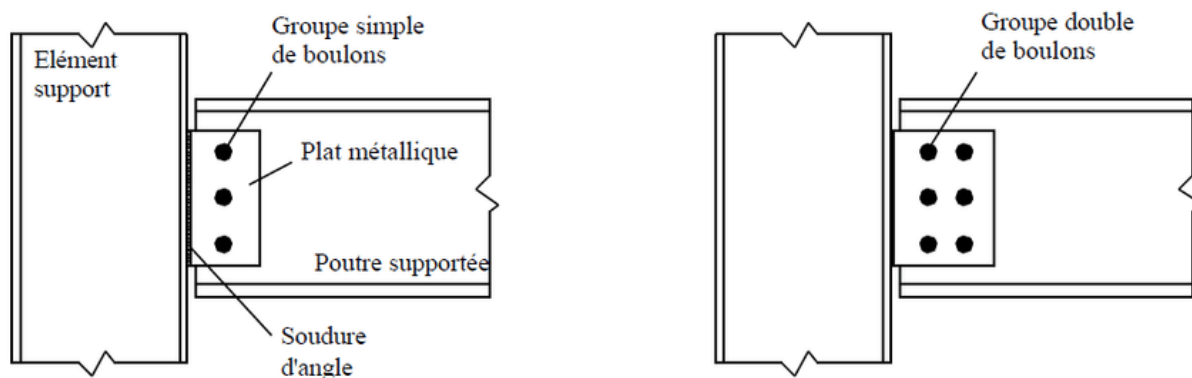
assemblage poteau poutre principale (illustratif)
